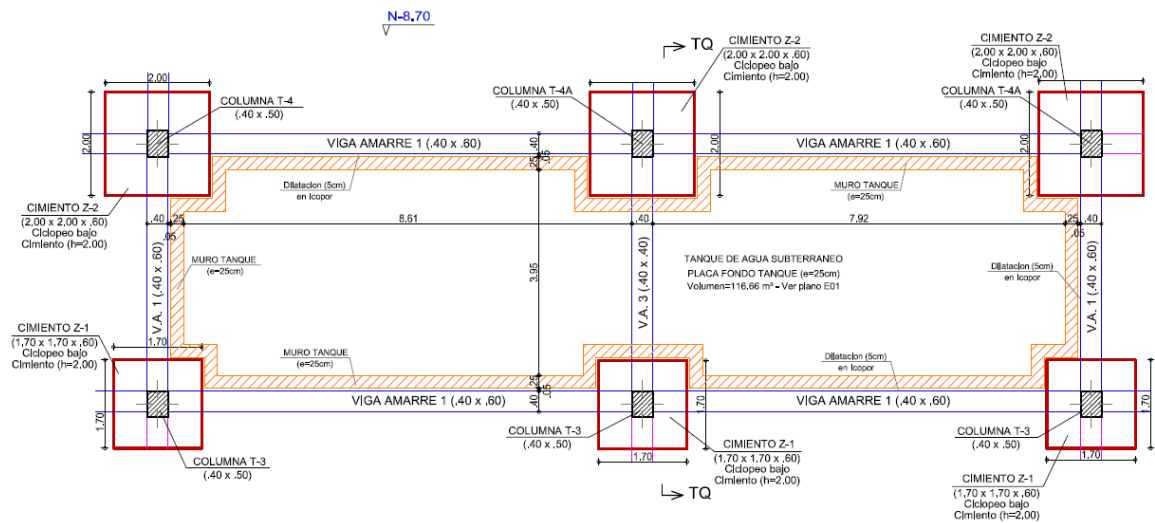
Detalle en planta de dimensiones y tipo de elementos del tanque.
